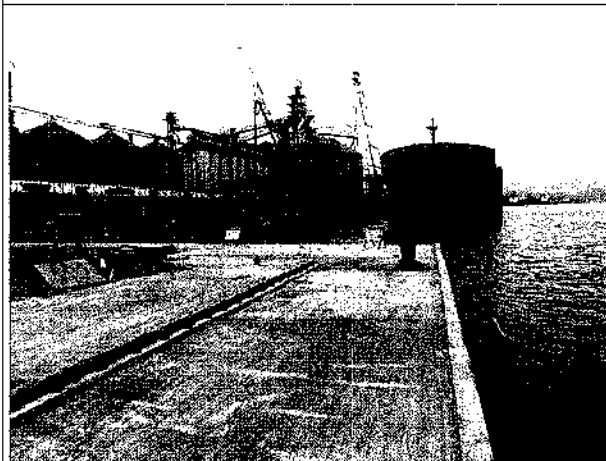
Cais do Outeirinhos (PAC-COPA). Em primeiro plano, o trecho que já foi retificado (Foto: Nelson Yoneda).
